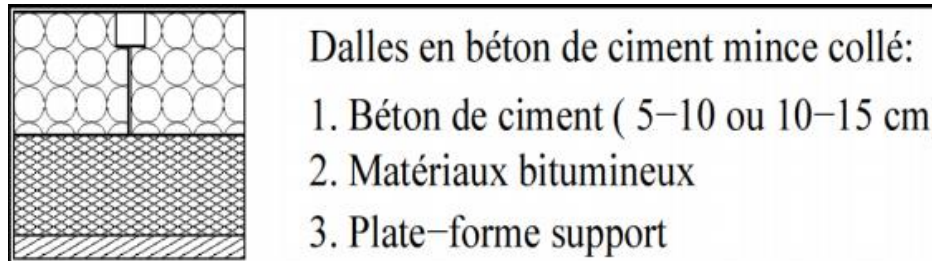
Chaussée avec une dalle en béton de ciment mince collé (BCMC) [10]
